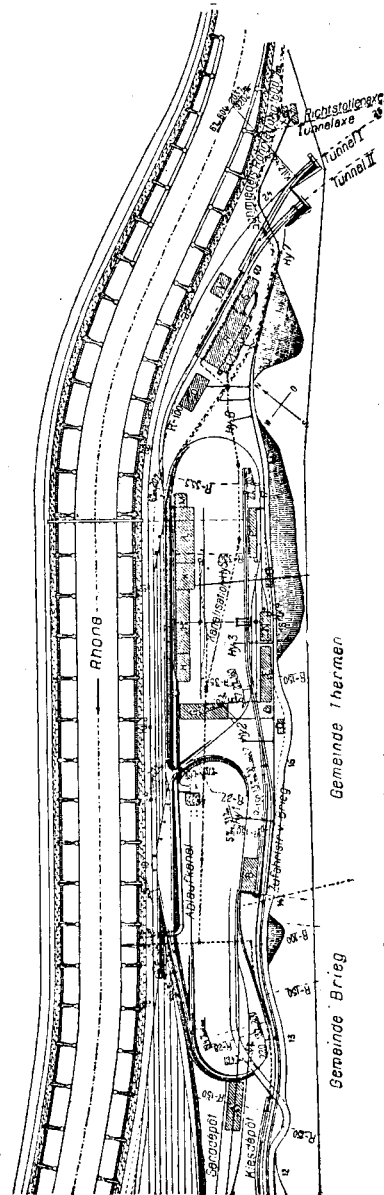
Plan terrier des installations à Brigue (Suisse). Echelle 1 : 5,500.
